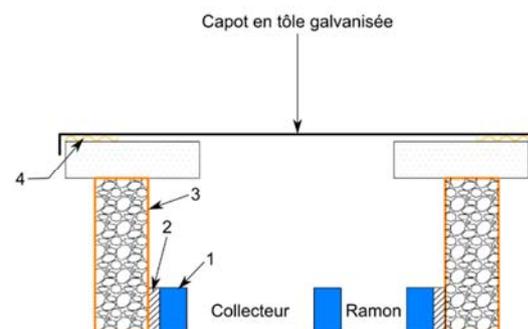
Coupe horizontale d'un plénum sur souche
